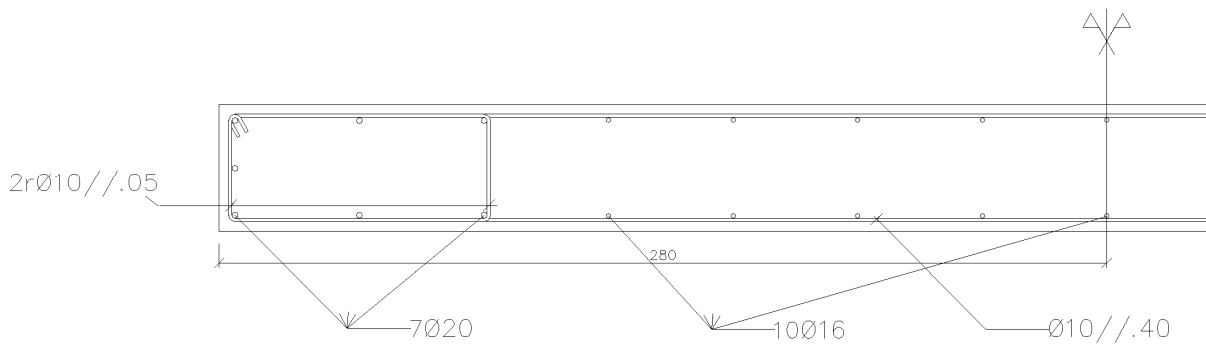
Solução de armadura na parede Pa9 (metade da rigidez) [cm]
